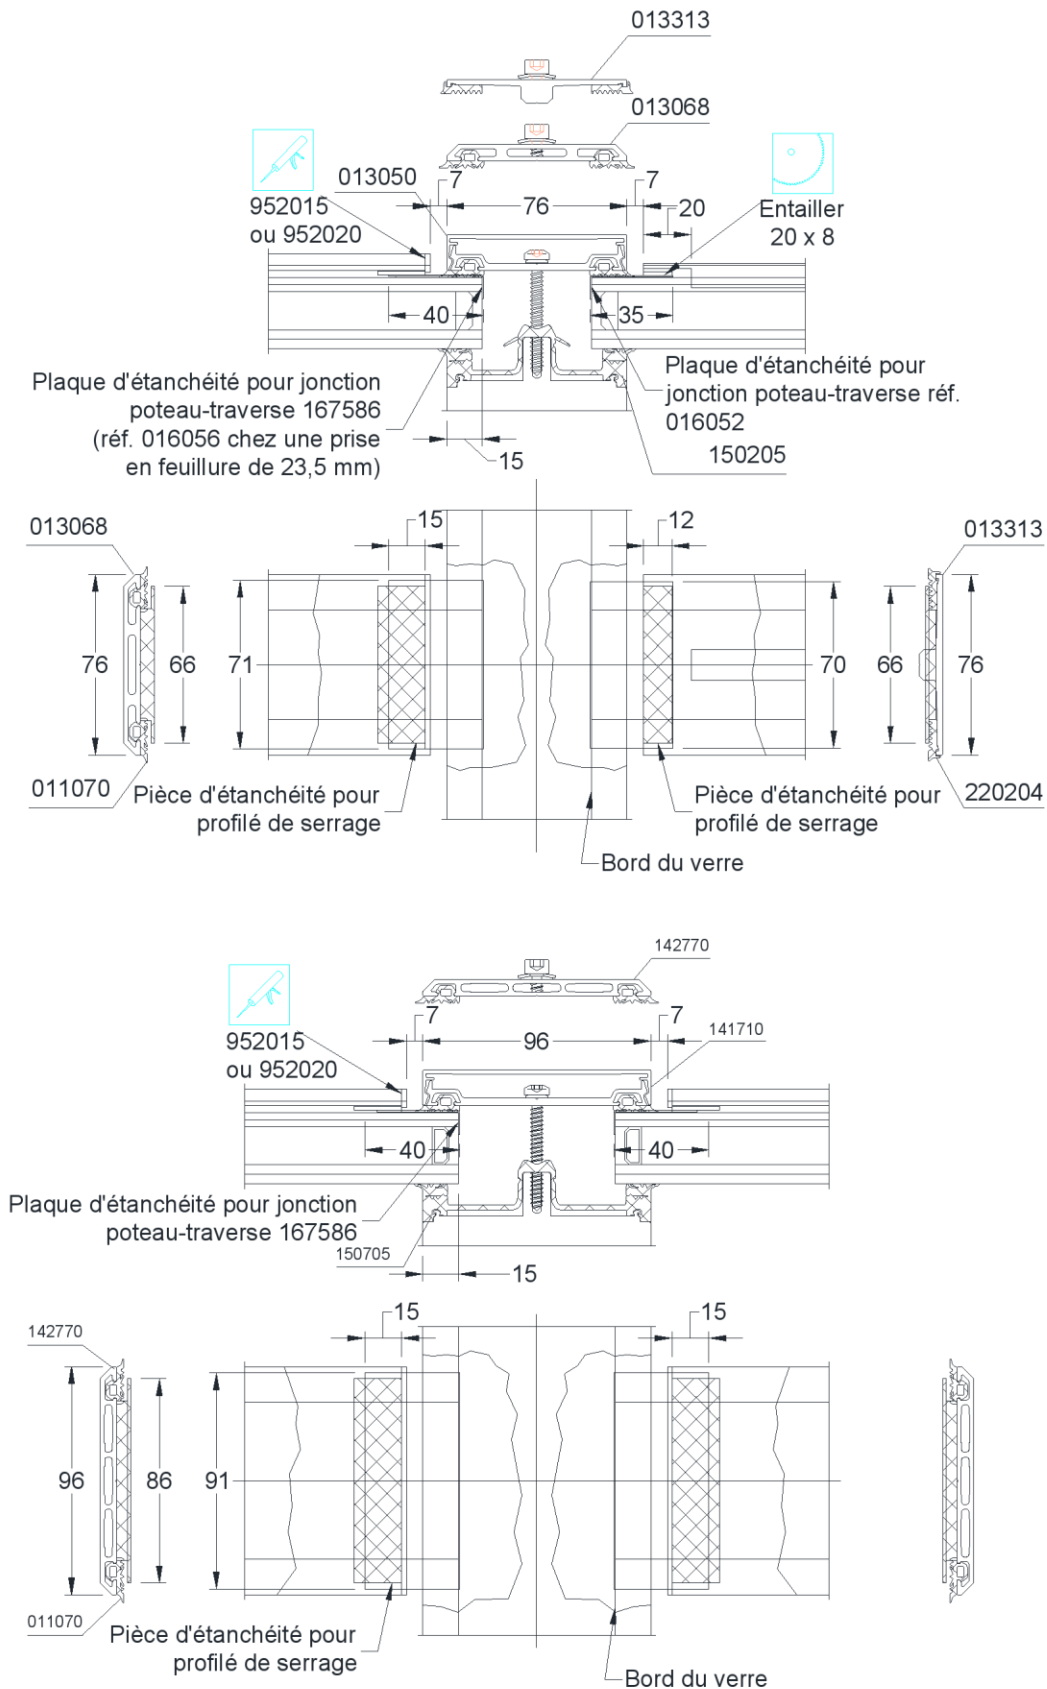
bis – montage des plaques d'étanchéité de croisement et des pièces d'étanchéité de profilé de serrage
